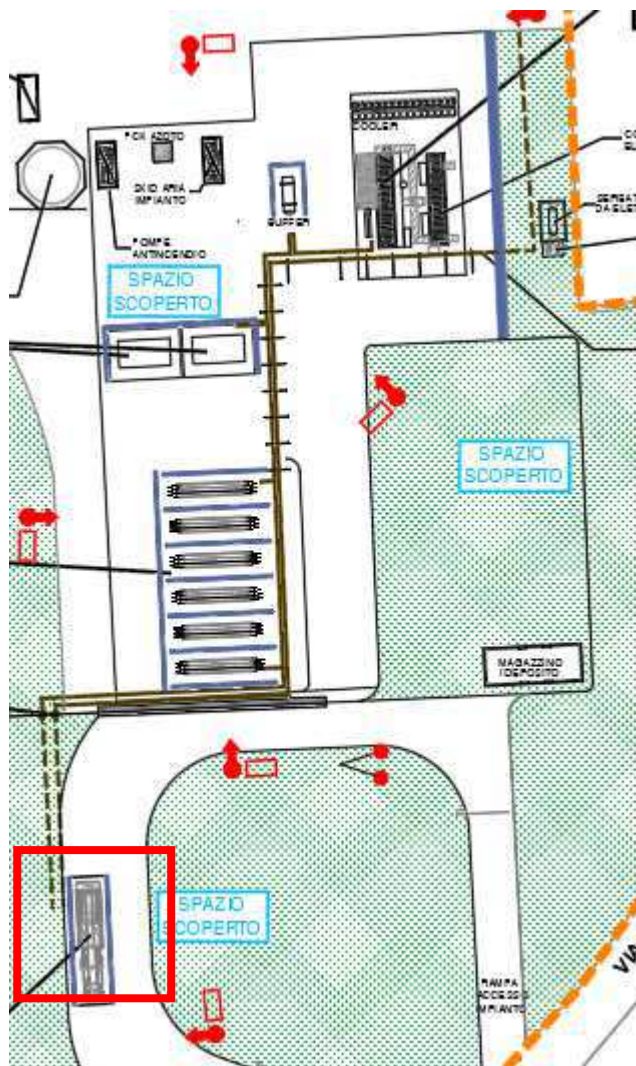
Individuazione planimetrica dei box per carri bombolai nel Lotto 1
